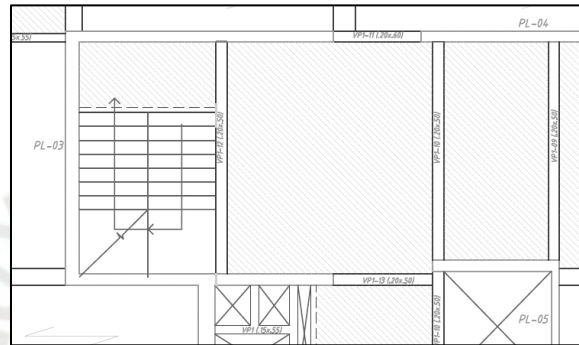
VISTA EN PLANTA DE LA ESCALERA A DISEÑAR.
